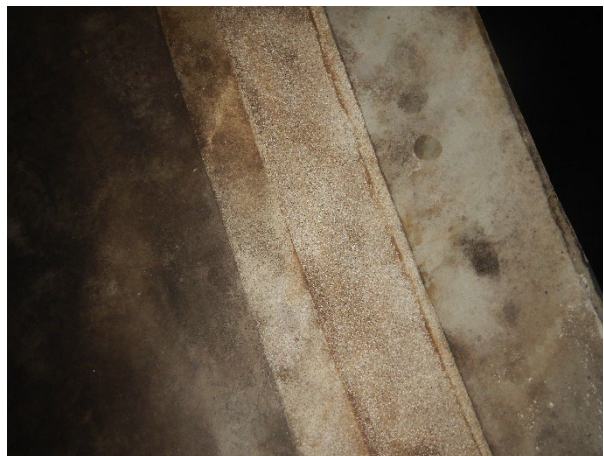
Bovenaanzicht slijtlaag omloopbaan.
